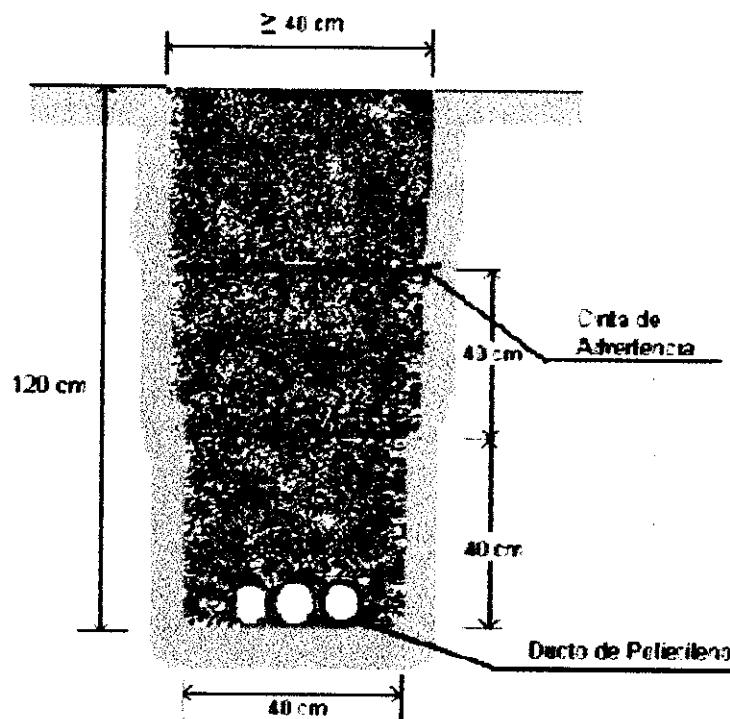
Perfil de Instalación del ducto, cintas de advertencia y colocación de capas de relleno utilizando retroexcavadora
